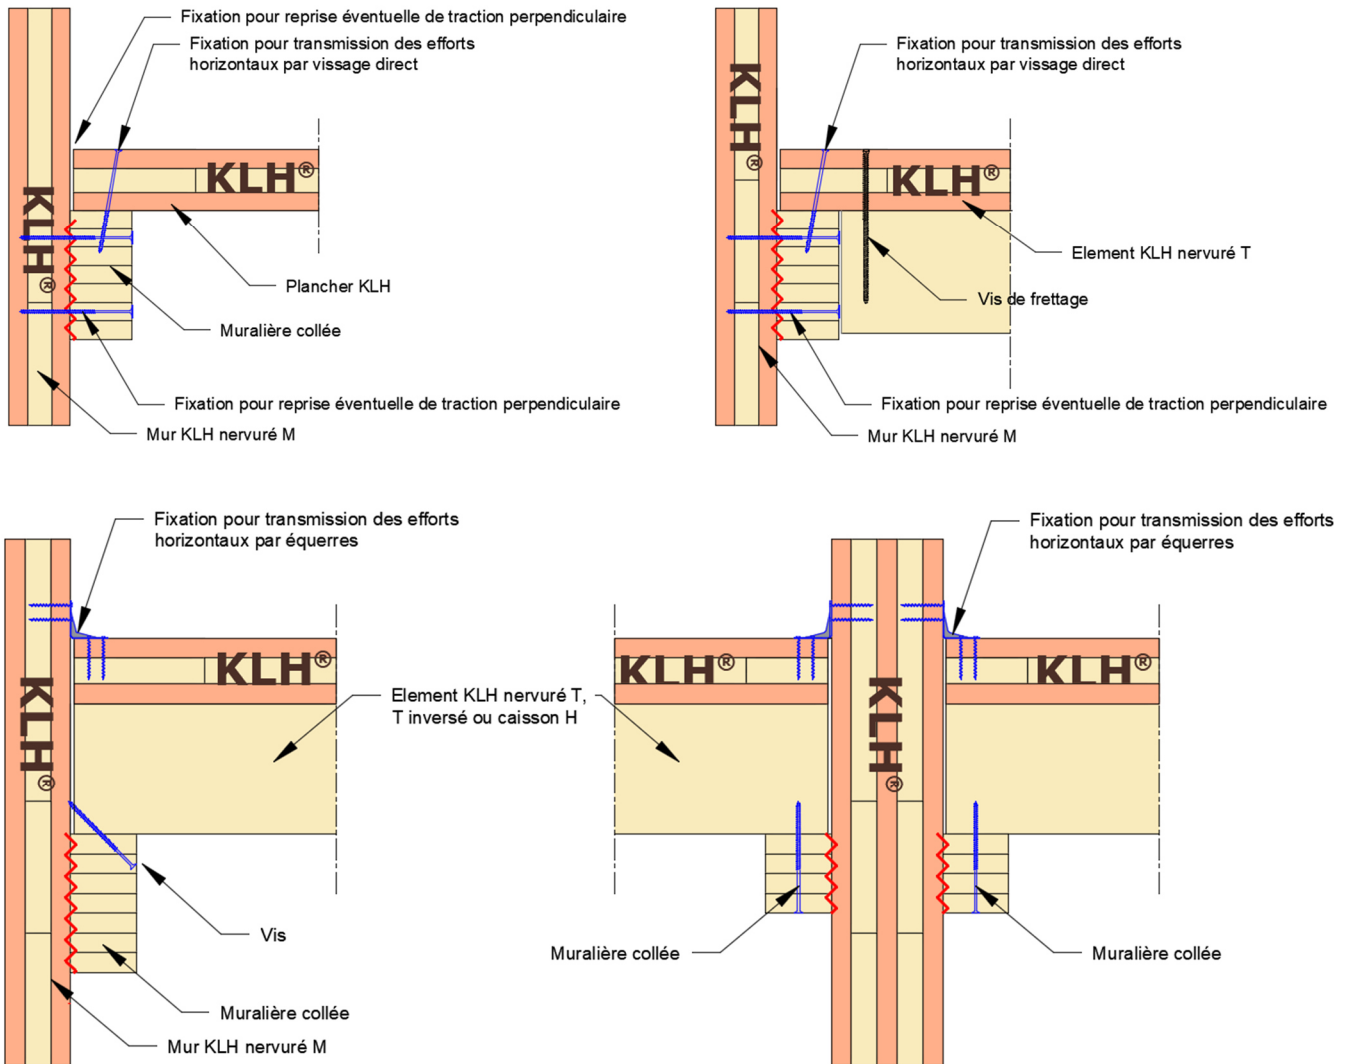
Détails d'appuis usuels sur Mur KLH®-CLT nervuré M (muralière collée structurellement)
